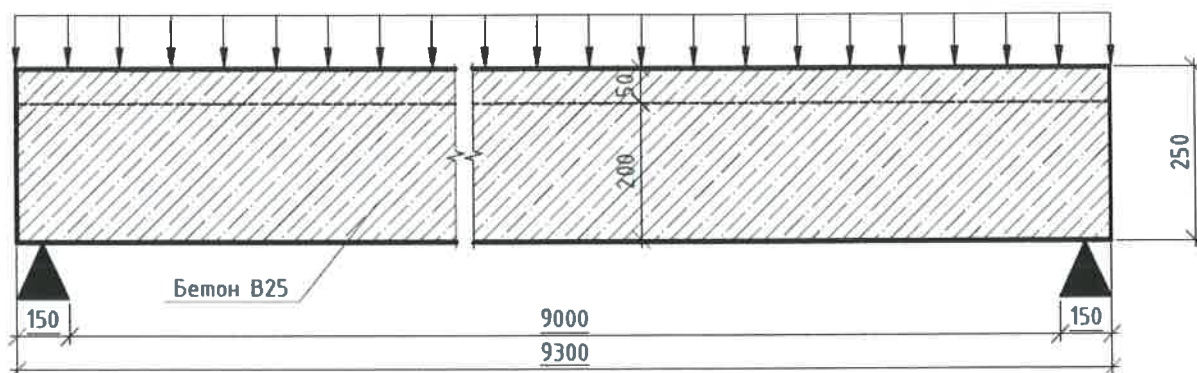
Общий вид и схема испытаний плиты по однопролетной схеме
